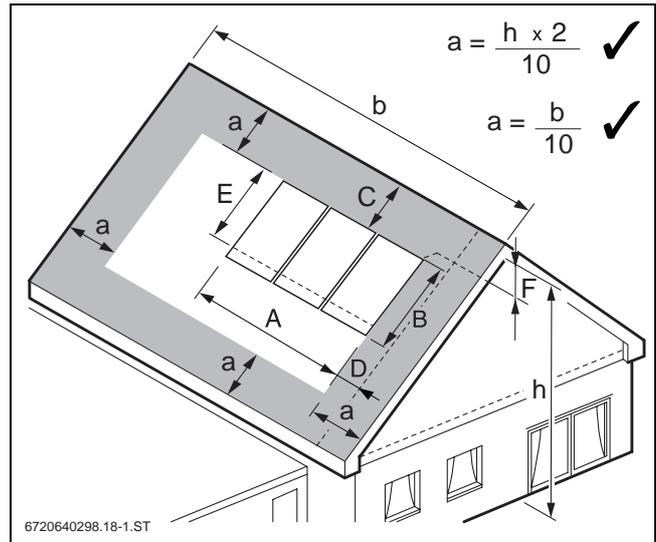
Fabbisogno di spazio per il montaggio sopra tetto di collettori piani (spiegazione nel testo)
